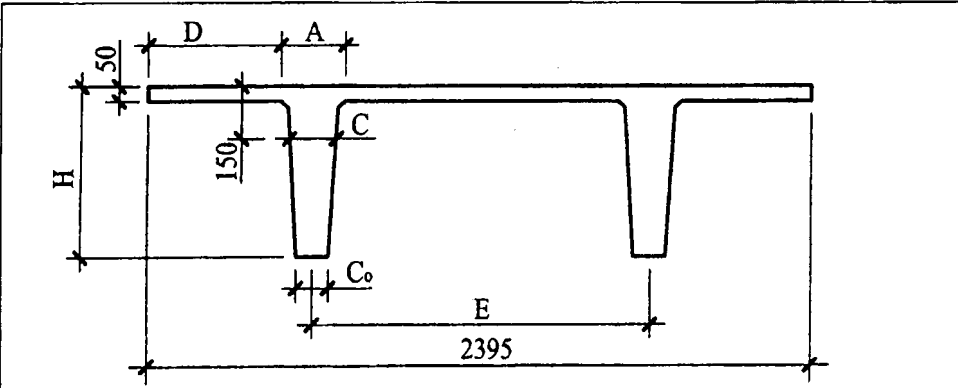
Габаритные размеры плит типа «2Т»
